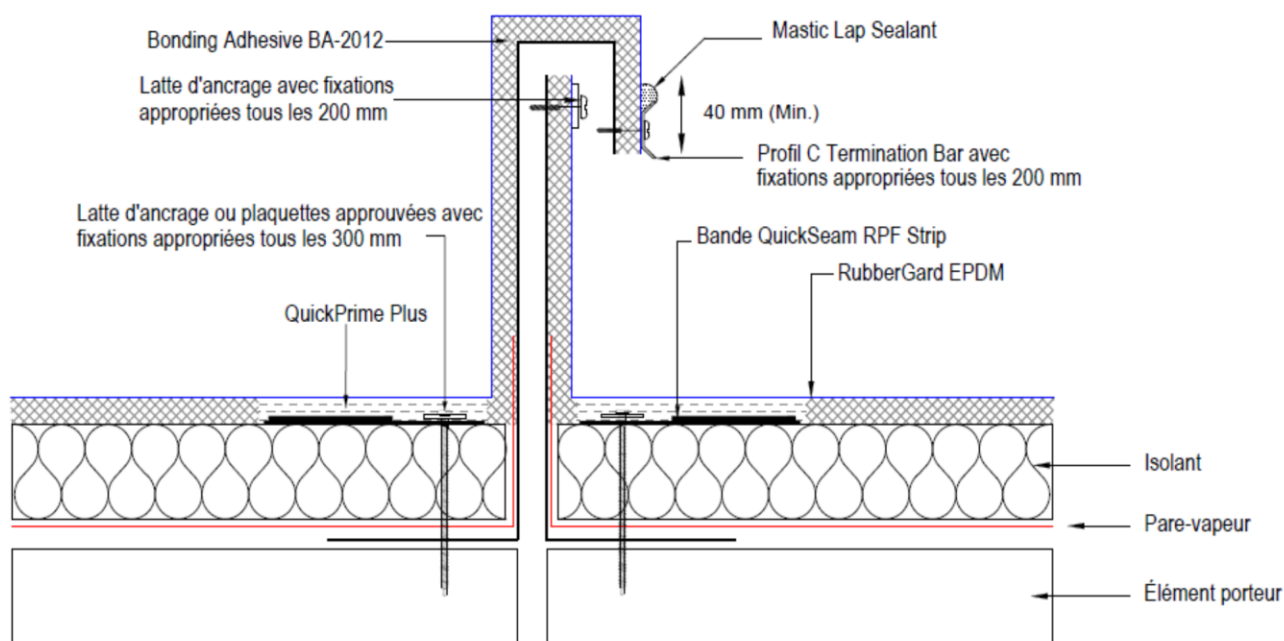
Relevé d'étanchéité – Terrasse accessible EPDM LSFR 1.5mm, protection dalles sur plots, travaux neufs, et sur locaux à très forte hygrométrie.
